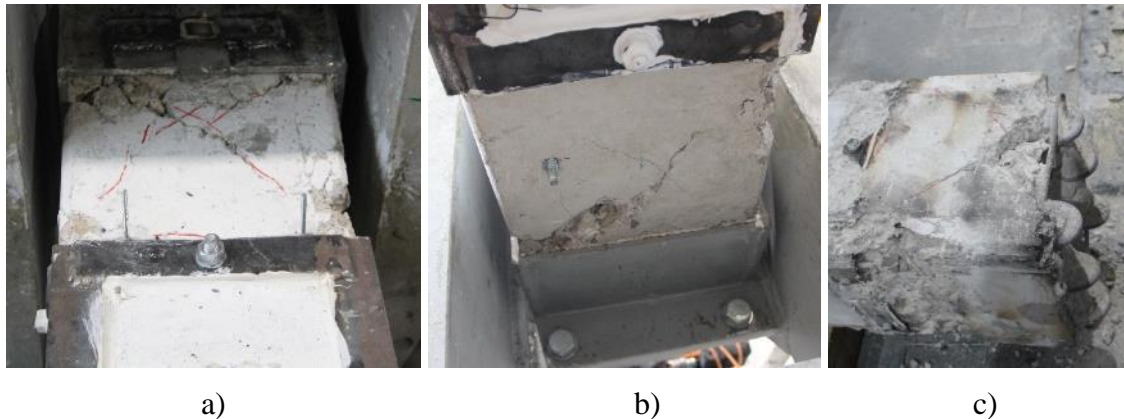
Rotura na base do pilar inferior: a) vista superior; b) vista superior; c) pilar após retirada da plataforma de ensaio
